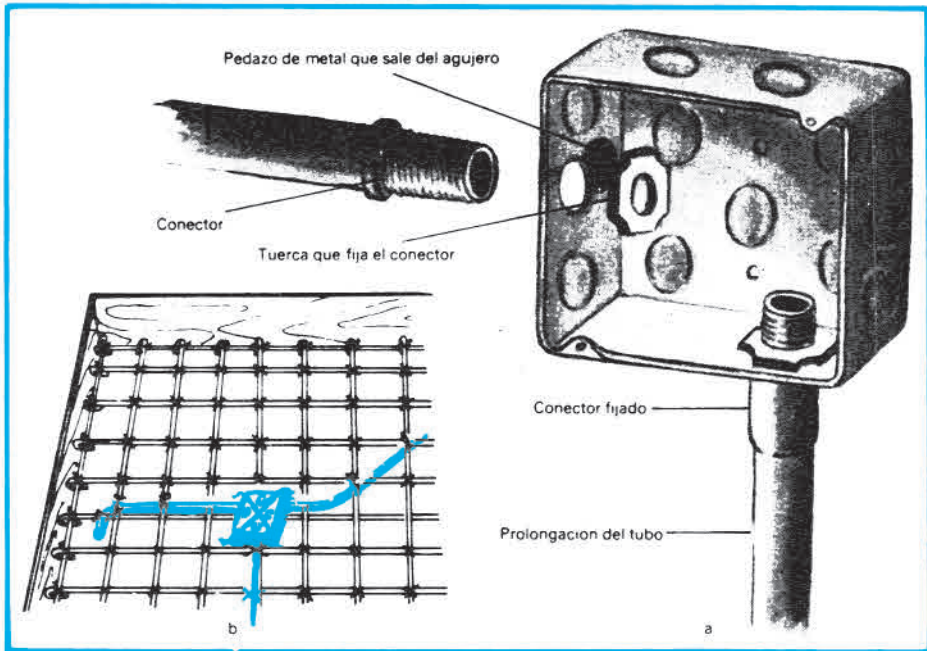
Colocación y fijación de los tubos a las cajas y estas al encofrado: a) fijación de las tuberías a la caja; b) forma de situar y amarrar una caja eléctrica al encofrado.
